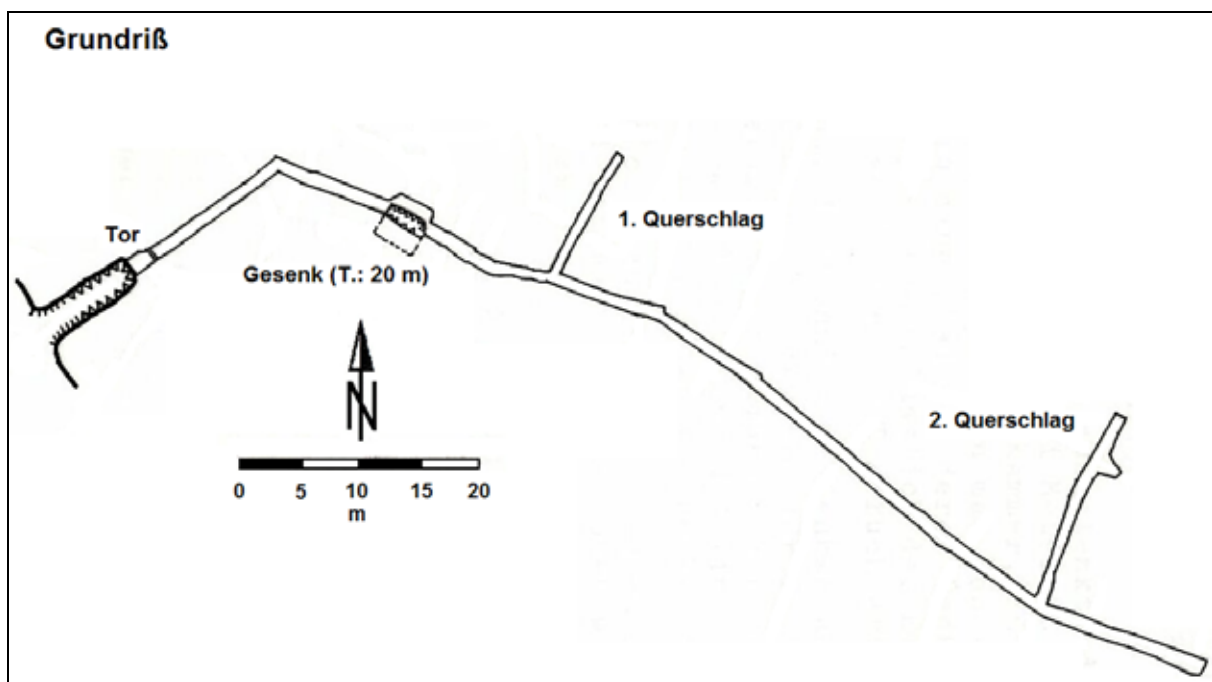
Grundriss des St. Georg-Stollens (nach RATHGEBER 1973)
